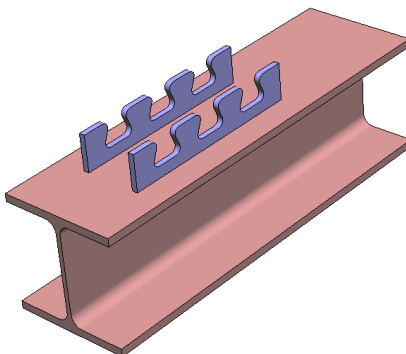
Dois Crestbond em paralelo sobre um perfil metálico.
